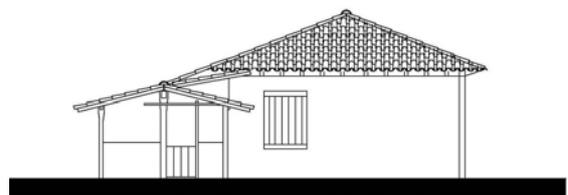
Fachada Leste (Acervo PROAU/FAU/UnB).
